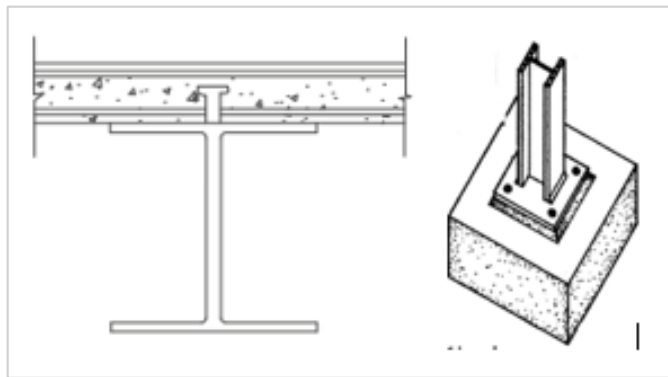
Perfil I viga de acero soportando losa de concreto y columna perfil H. fuente: (Arquitectura en Acero)
